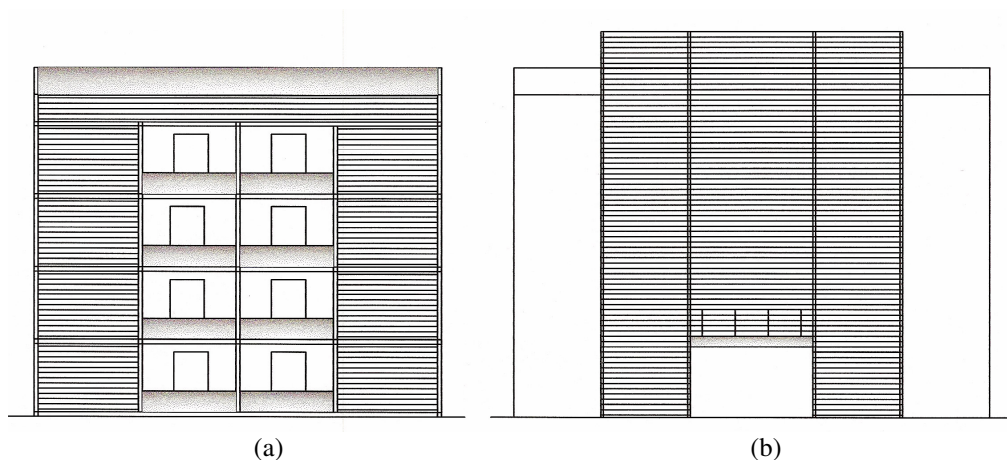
Propostas de fachadas – Opção B – (a) frontal (sacadas com posição fixa e brises móveis) e (b) lateral (estrutura e tela metálica como suporte para fachada verde)
